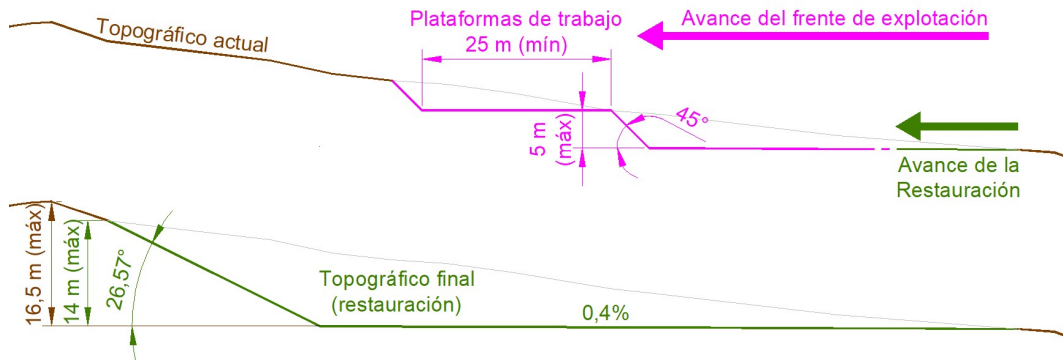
Modelo-tipo estructural en la extracción y en la restauración.
